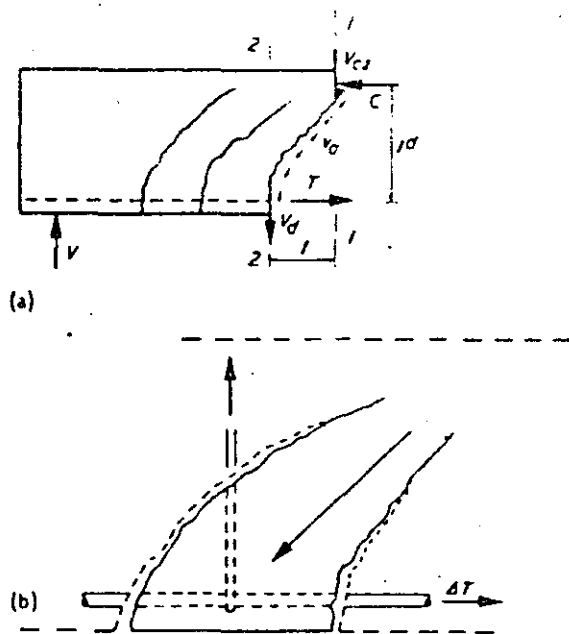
Mecanismo resistente al cortante en la viga. a) Las fuerzas internas resisten el cortante, sin que exista refuerzo en el alma. b) voladizo en el concreto que actúa como puntal, con la existencia de refuerzo en el alma.
